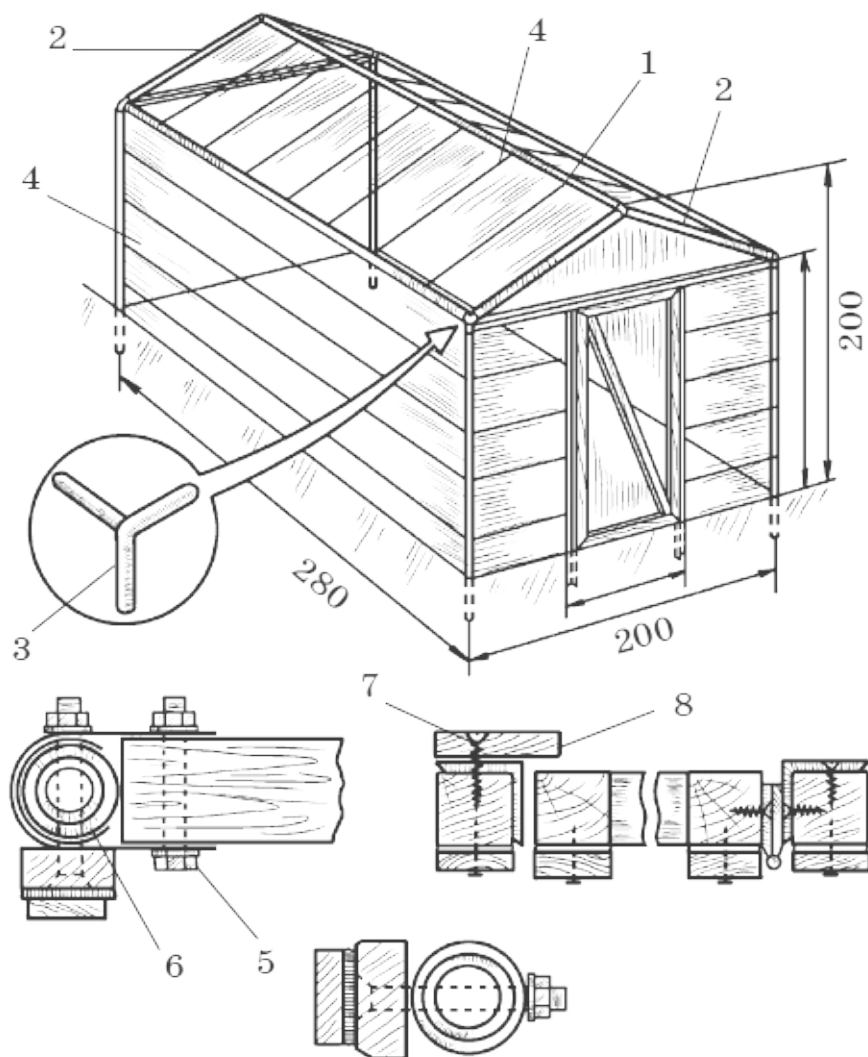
Переносной парник с использованием лески: 1 — отверстия для крепления лески; 2 — трубы; 3 — вставка; 4 — леска; 5 — скоба; 6 — листовая резина; 7 — упор для двери; 8 — уголок
